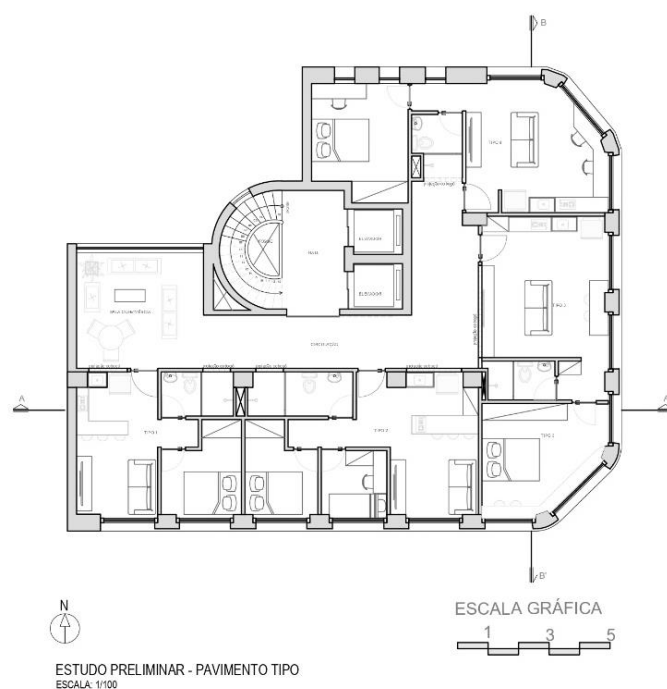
Planta baixa de estudo preliminar do pavimento tipo na fase pós-design. Elaboração própria dos autores.
